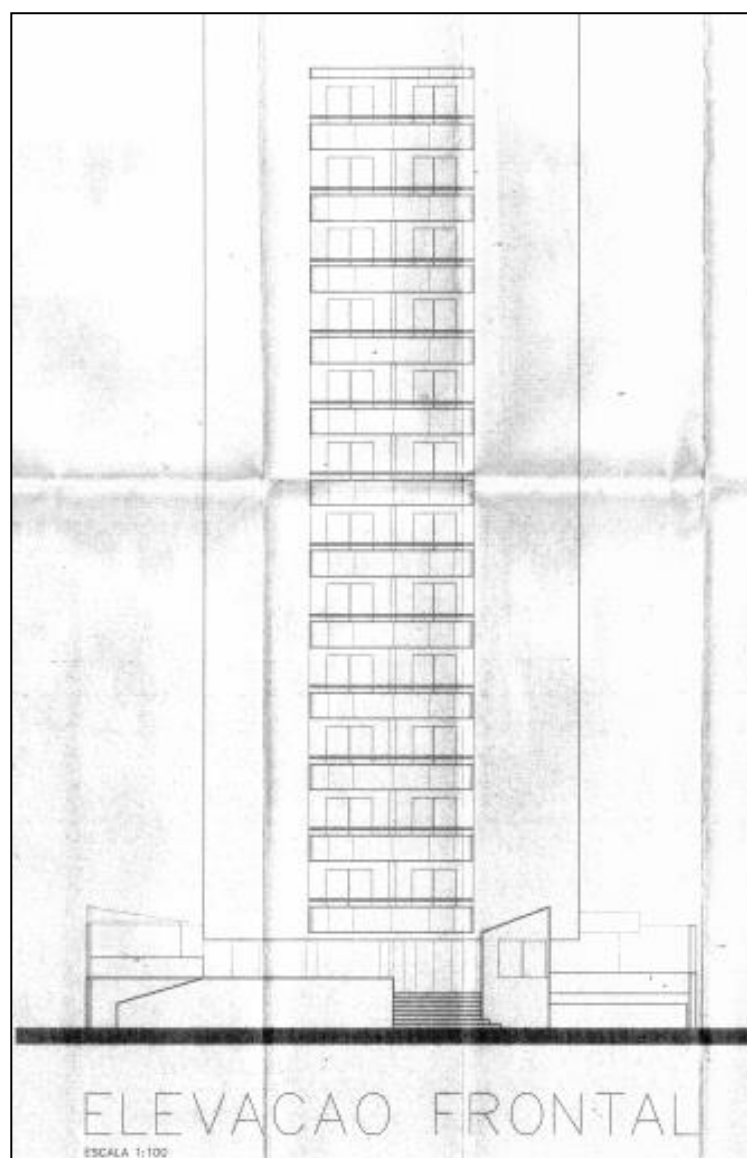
Elevação frontal edifício. (Fonte: arquivo pessoal).
